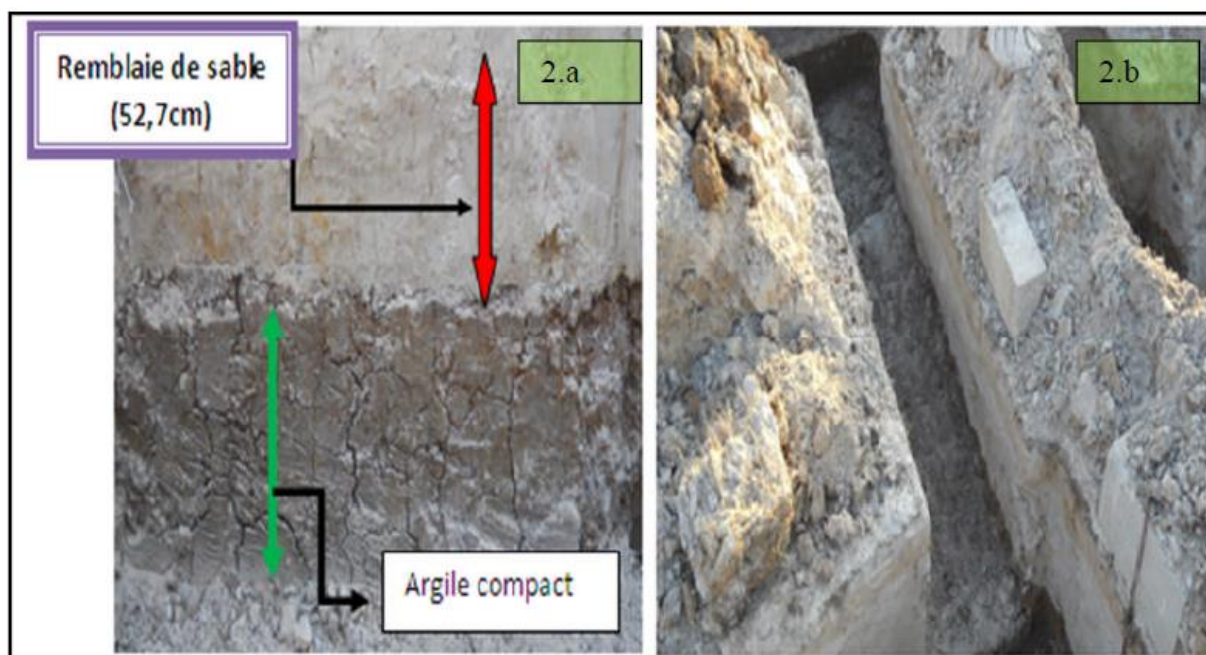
L'épaisseur du remblai d'une maison en construction à Goumel
